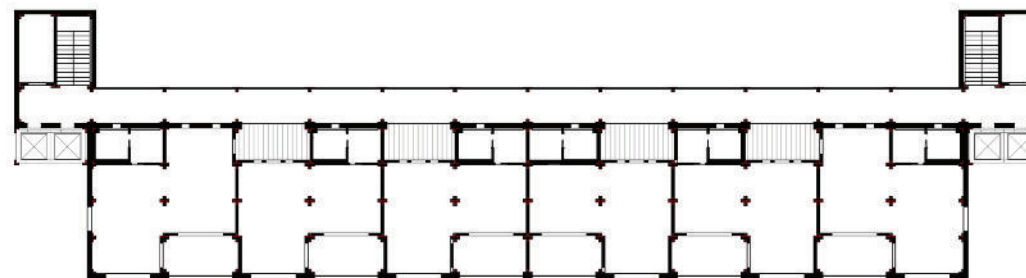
\_ Ipotesi di edificio a ballatoio \_ Planimetria piano tipo \_ Scala 1:500
